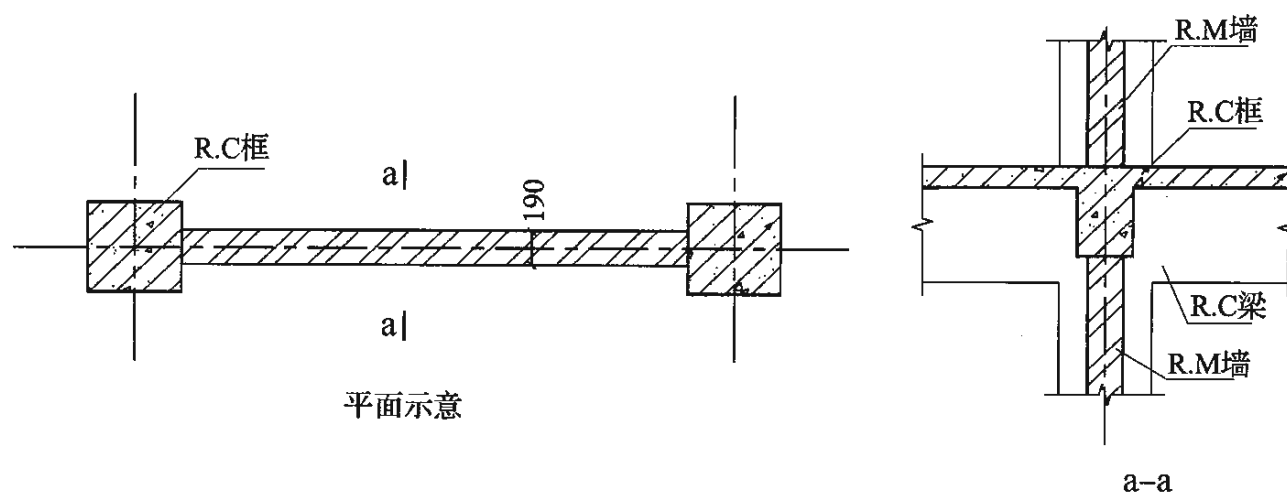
R.C 框架与 R.M 墙连接构造
